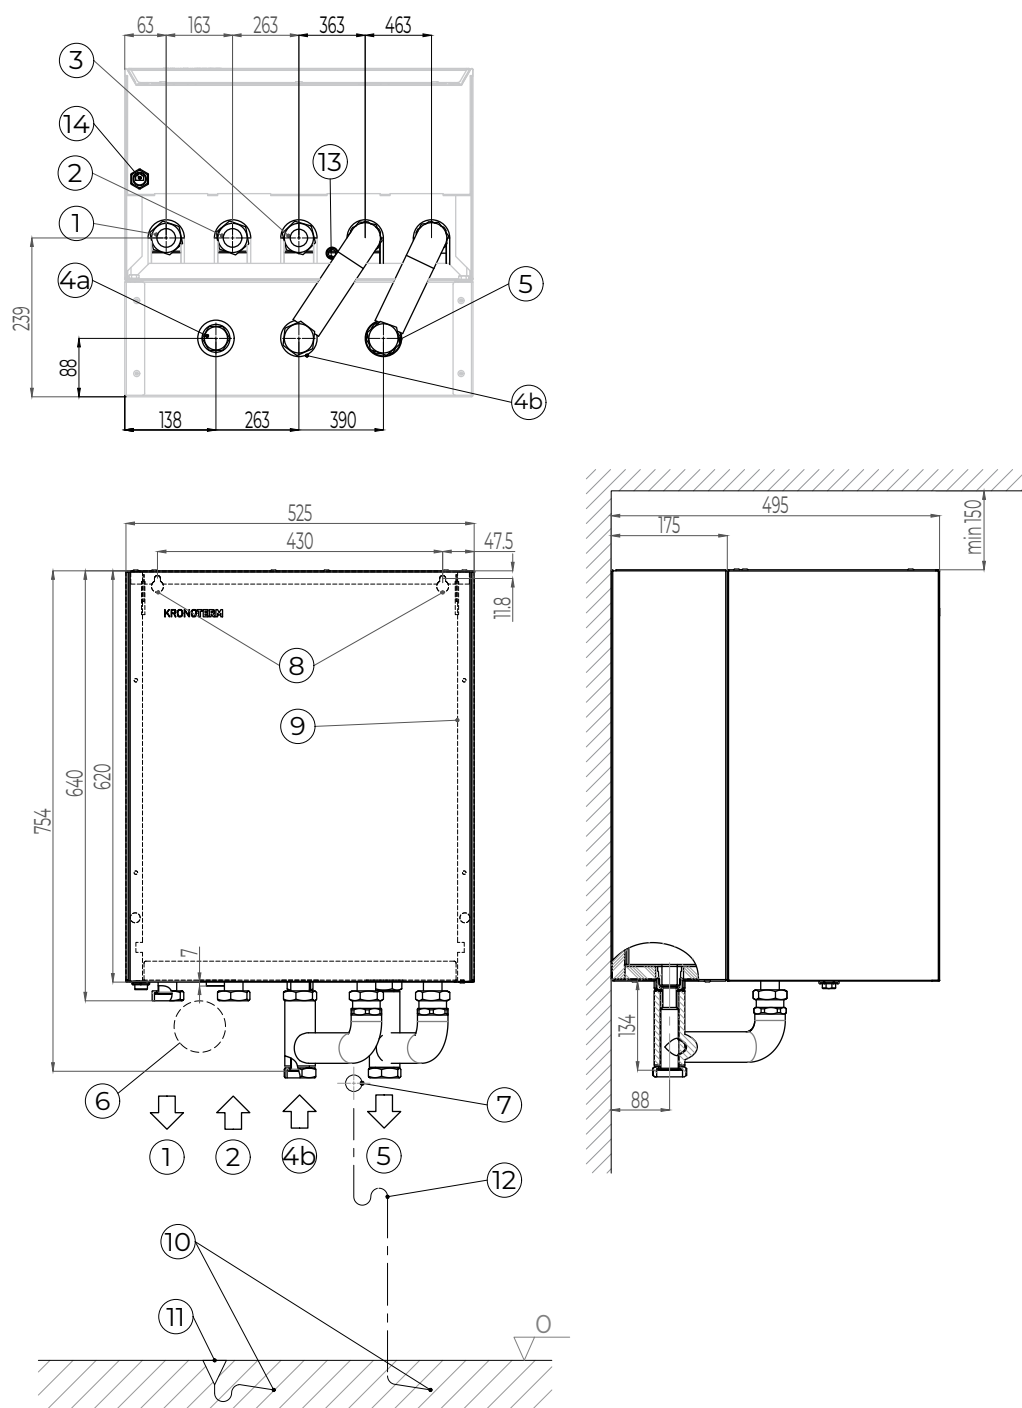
Bijlage 3 - Plan voor het installeren van de HYDRO S2 + HYDRO A2
